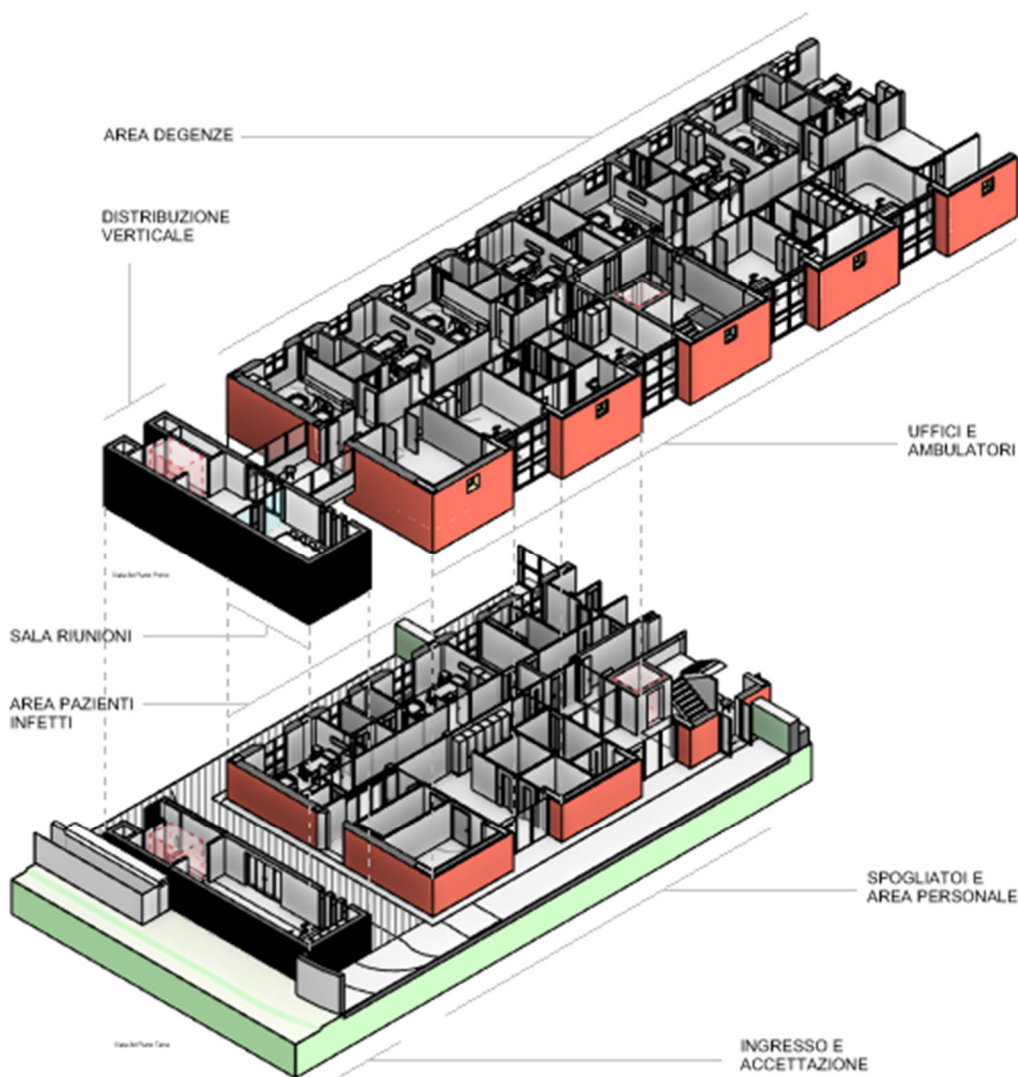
Esploso tridimensionale dell'intervento di progetto
